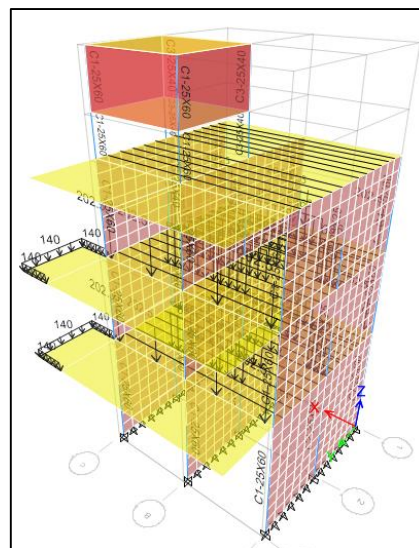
Bloque 3 cargas muertas lineales por tabiquería y parapetos
